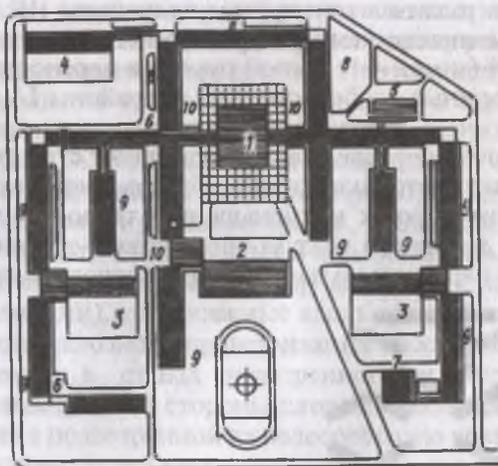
Схема планировки поселка на 3 тыс. жителей для условий особо морозного района: 1 — общественный центр; 2 — школа; 3 — детские ясли-сад; 4 — поликлиника; 5 — пожарное депо; 6 — 4-этажный галерейный дом; 7 — 9-этажный точечный дом; 8, 9 — 7- и 4-этажные секционные дома; 10 — зимний сад, переход-галерея
